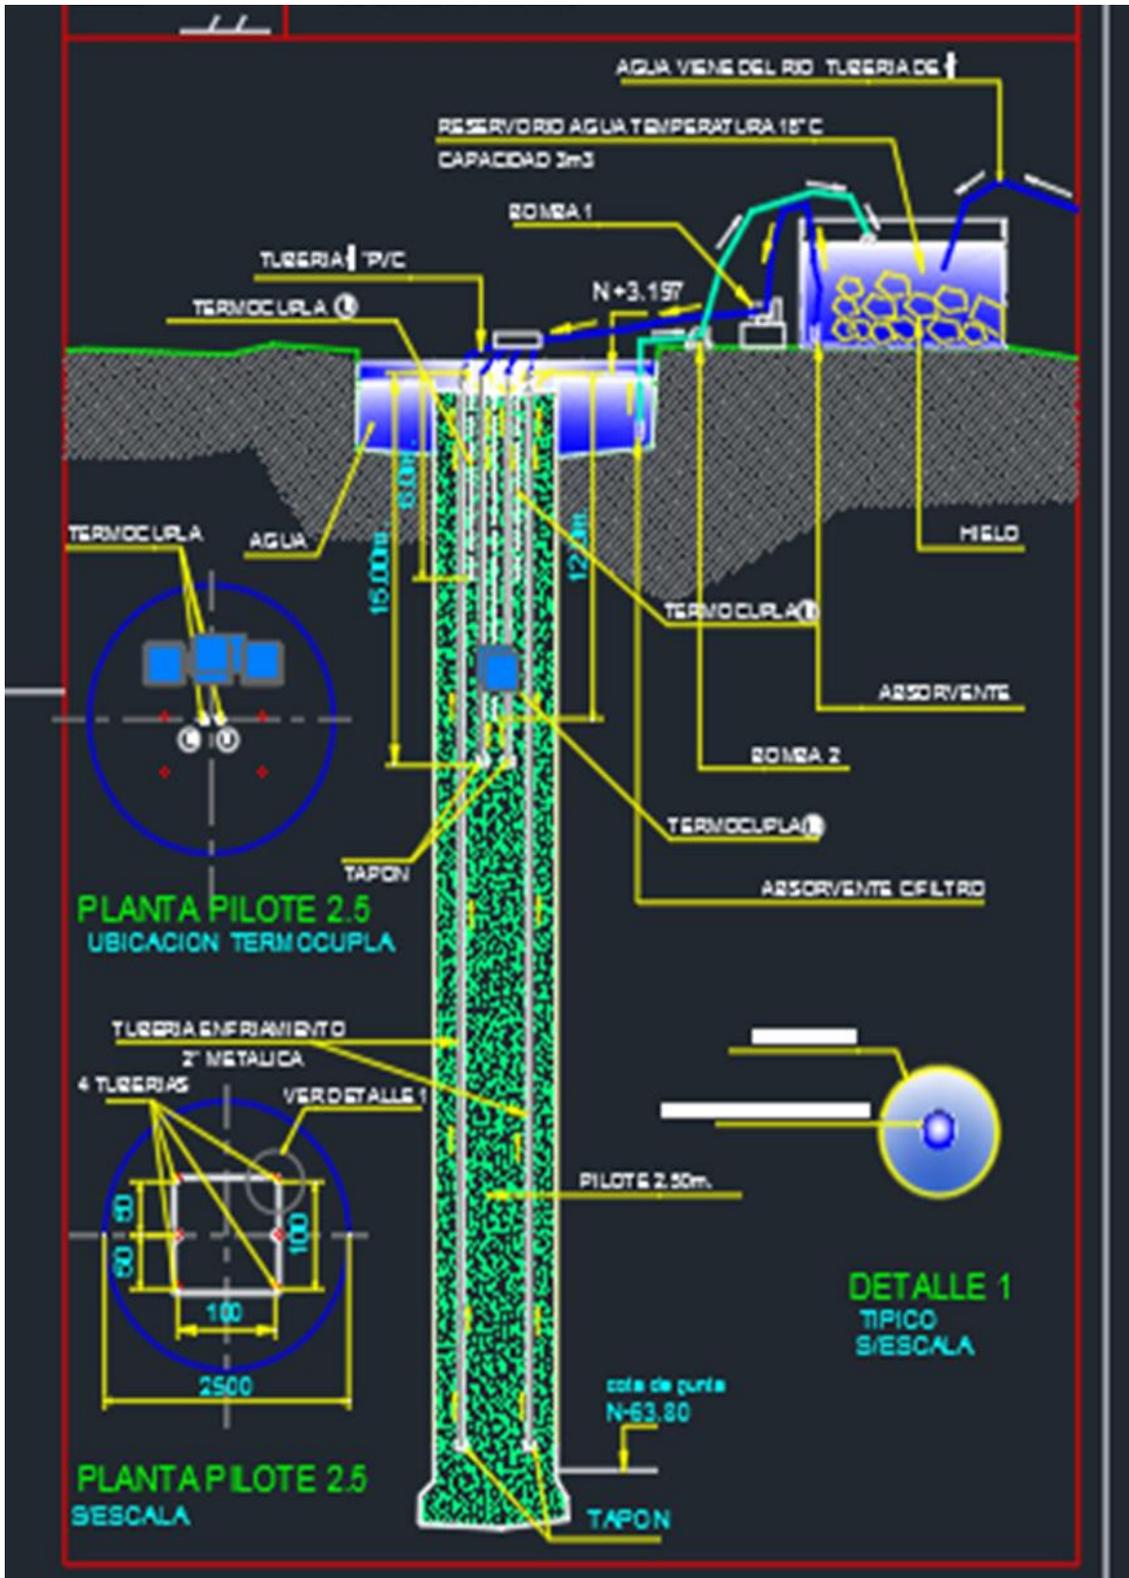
Esquema de la armadura del pilote e instalación de la tubería para el sistema de enfriamiento
